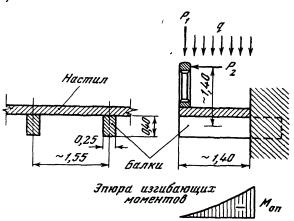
Схема работы каменной балки как опоры балкона с вылетом 1,40 м
